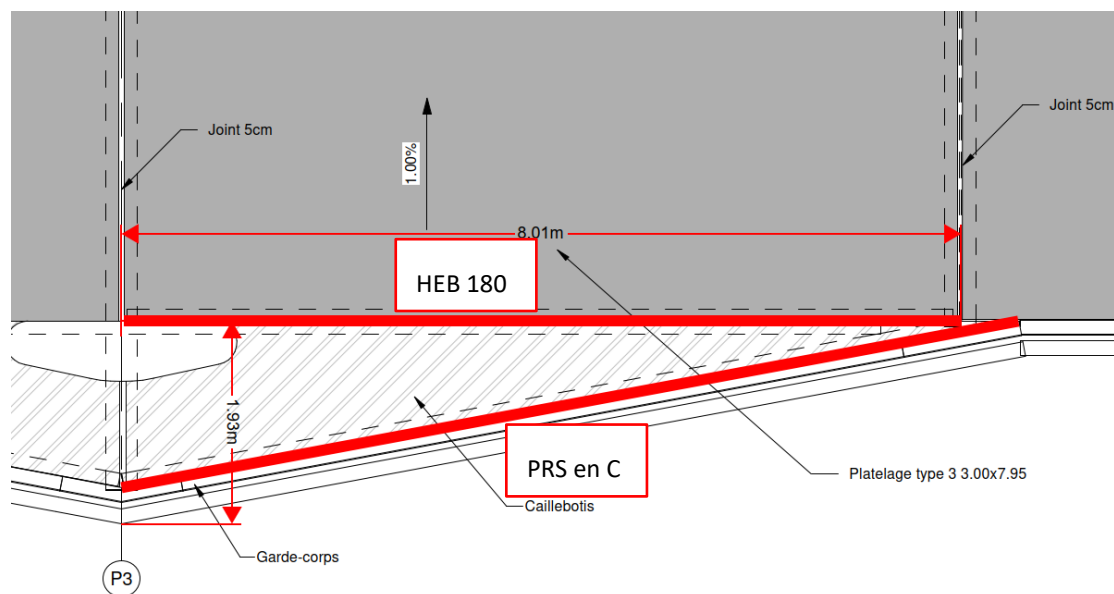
Vue en plan d'un belvédère – détails sur profilés métalliques
